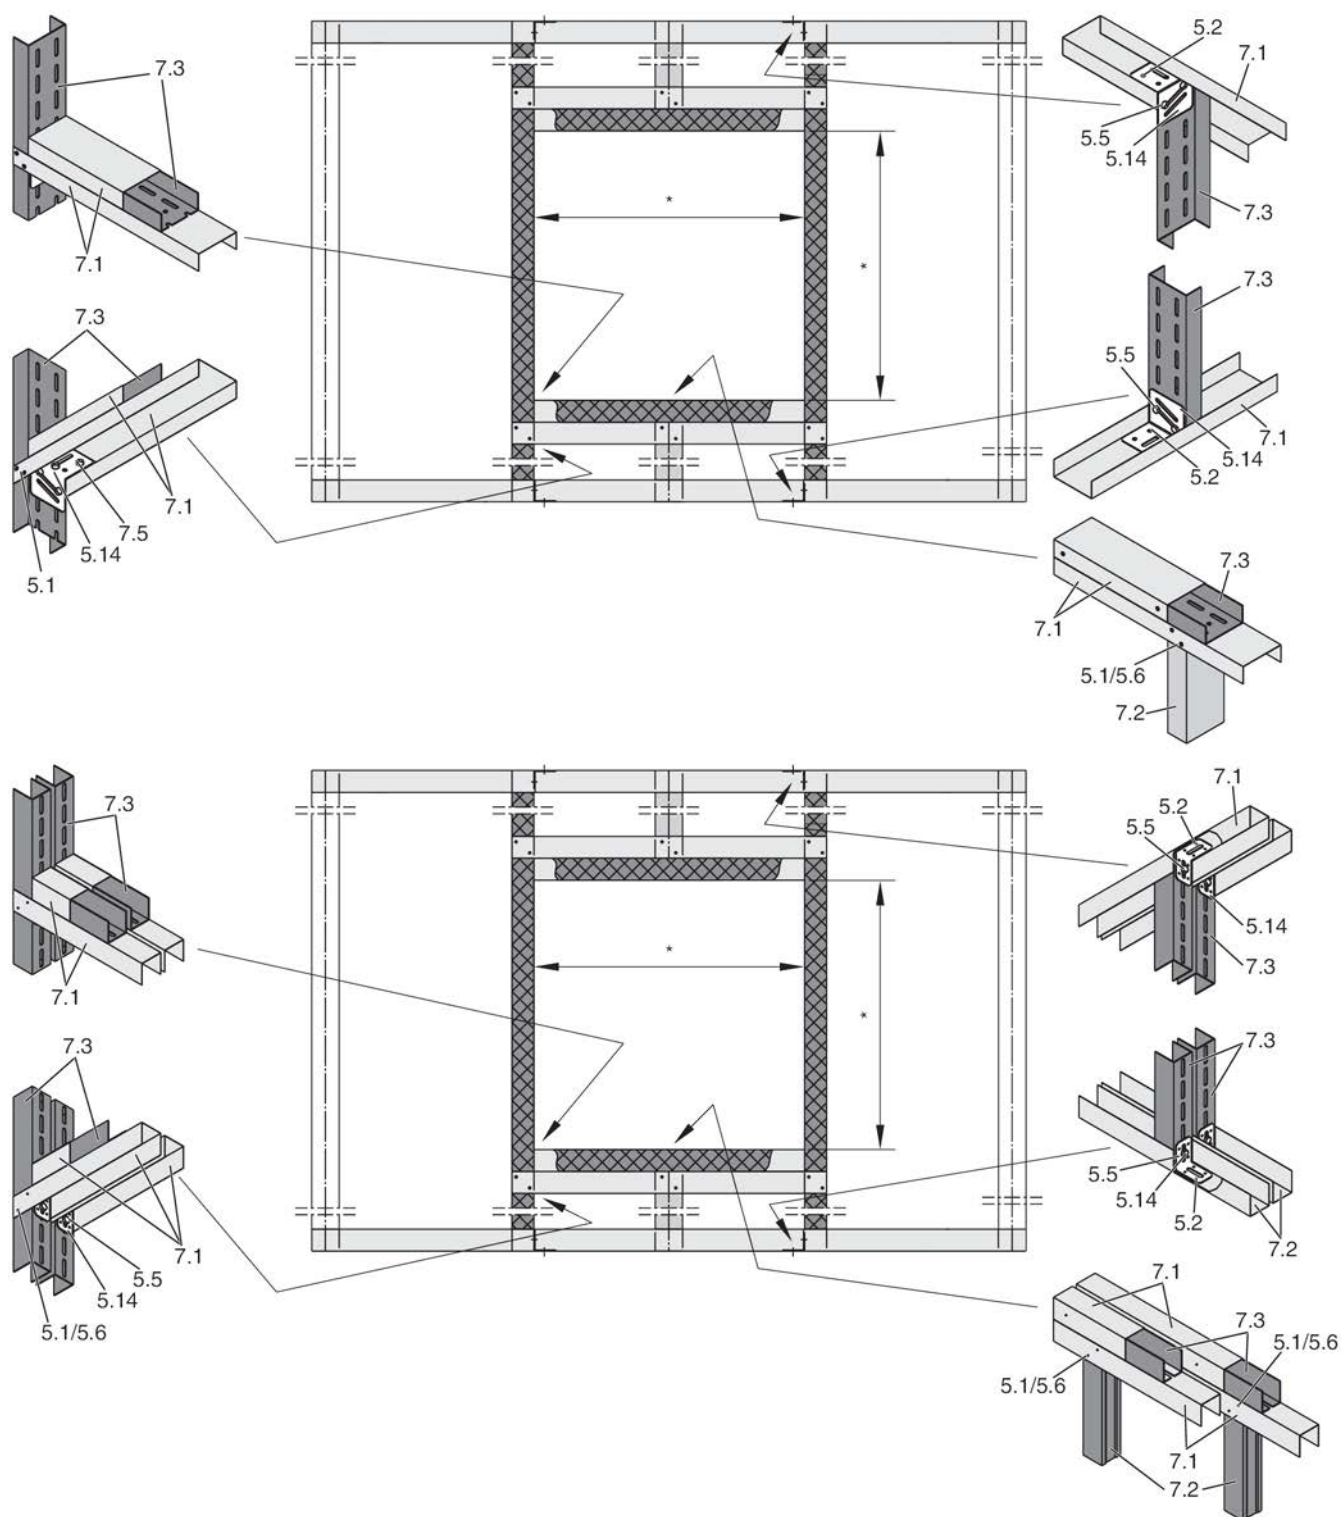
Metallständerwerk Brandwand, einfache und doppelte Ausführung
